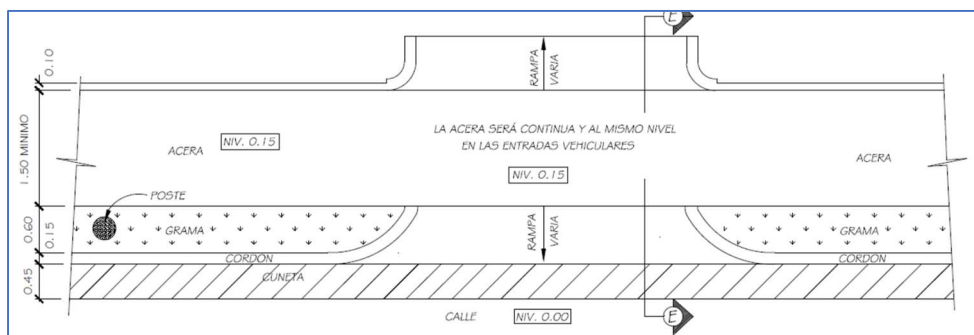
28. Planta de Rampa Vehicular en aceras
